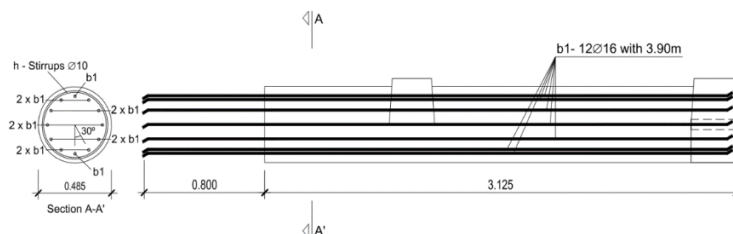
Armadura longitudinal do elemento B do modelo com ligações de barras salientes (modelo S3).
